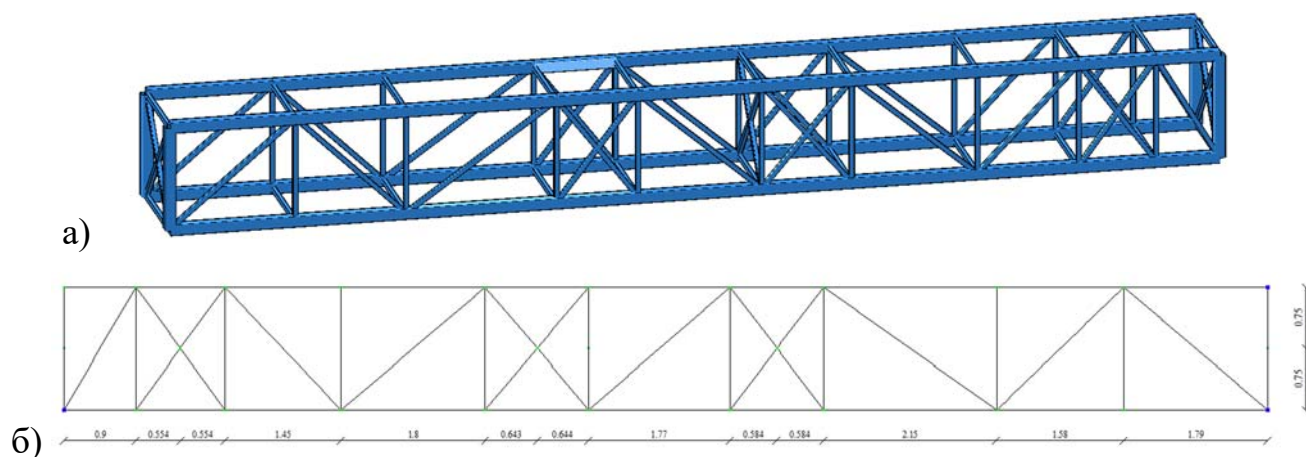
Розрахункова схема оптимального варіанту конструкції просторової ферми:
